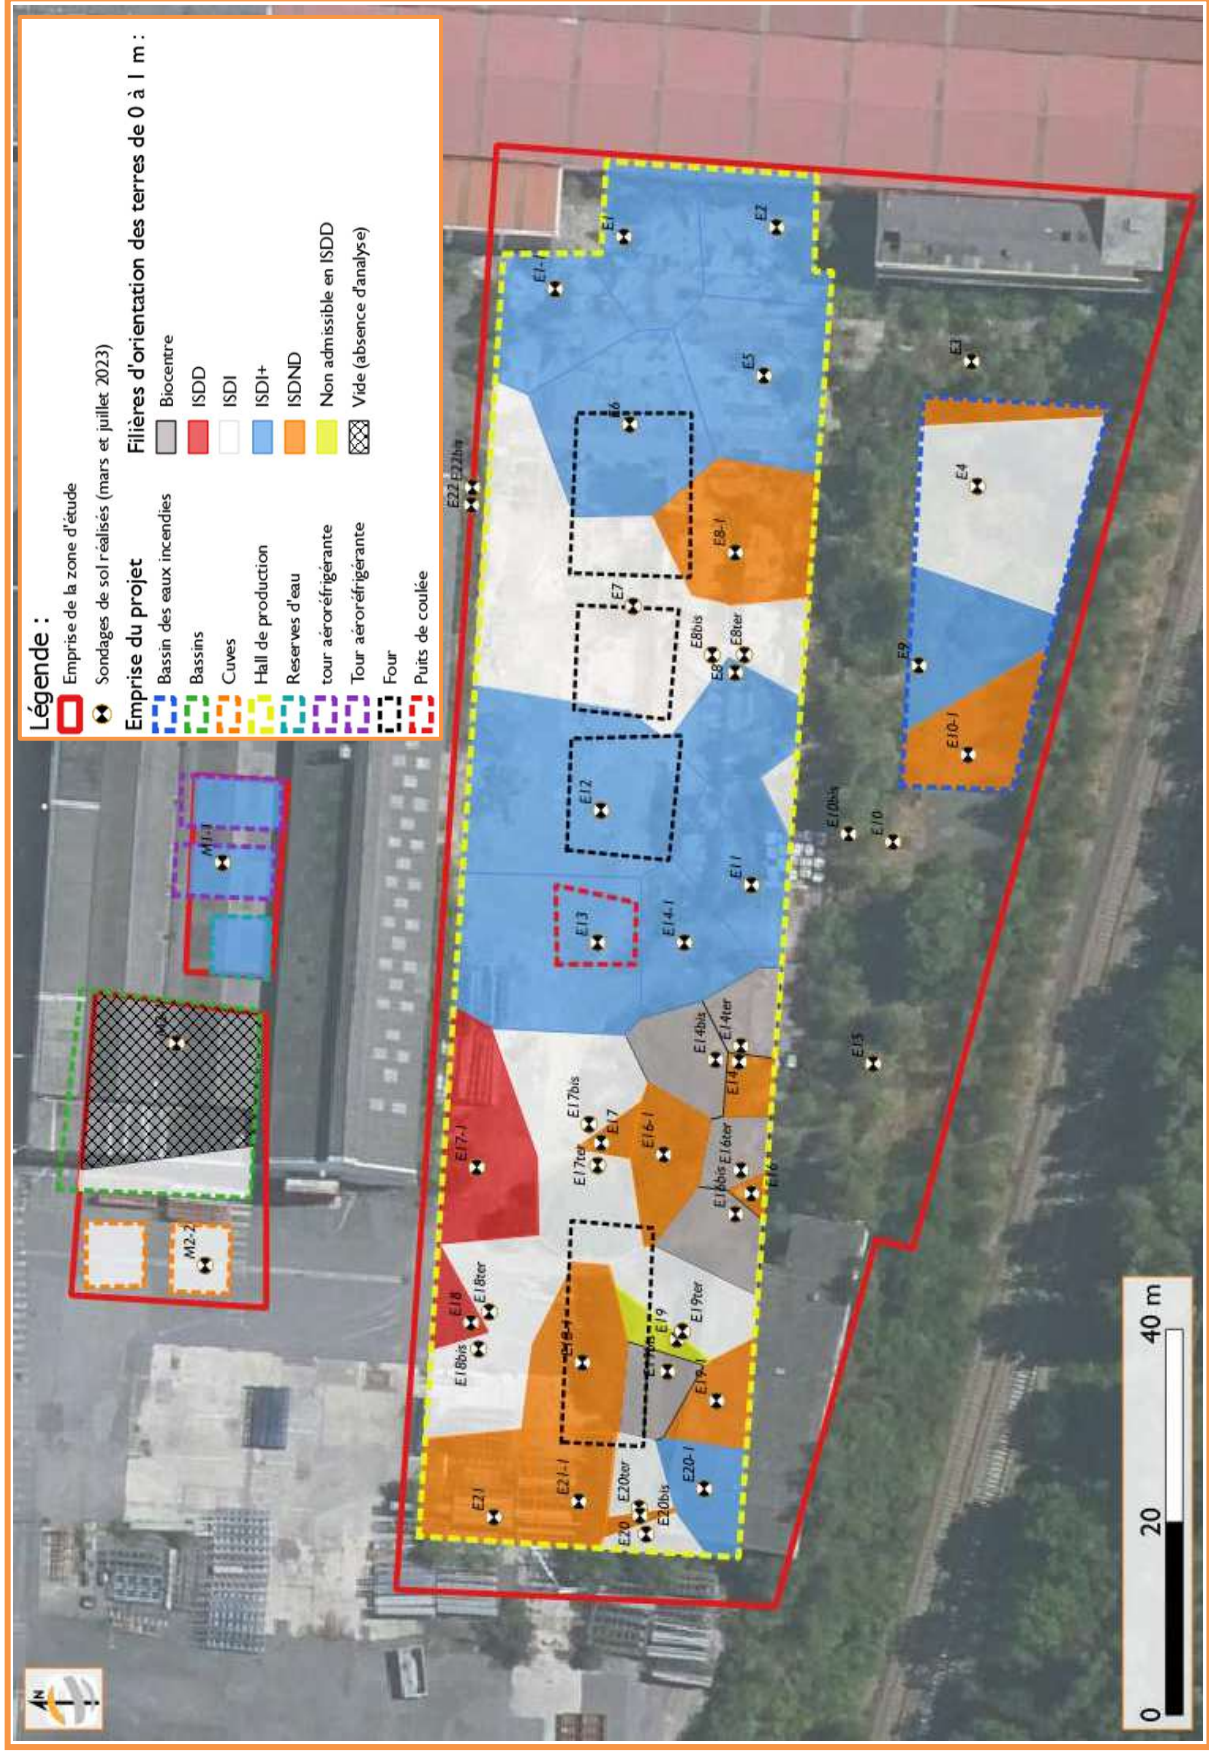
Plan de terrassement sur les terres à excaver entre 0 et 1 m
